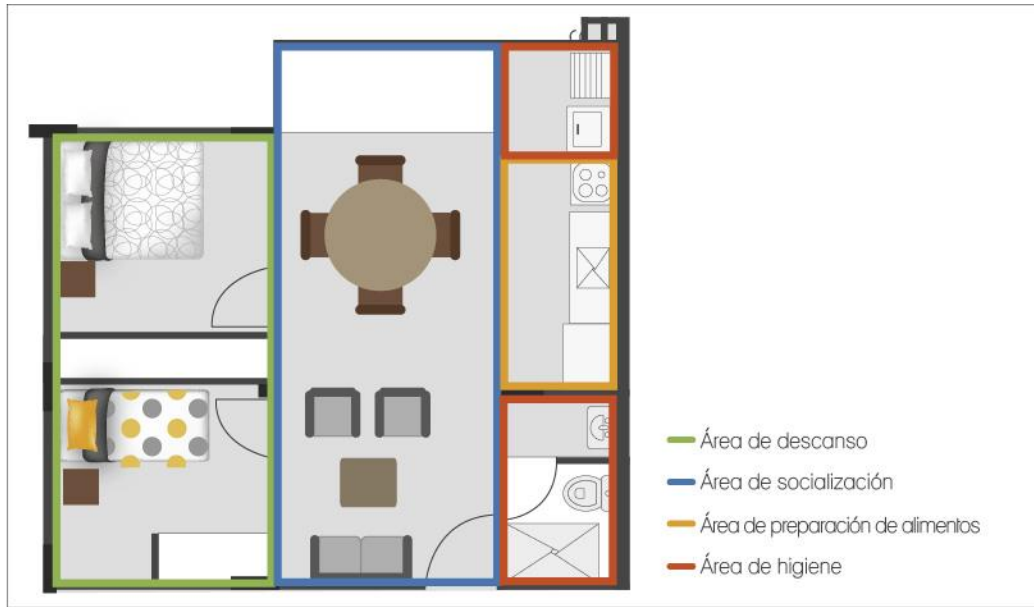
Vista en planta apartamentos ubicados en el barrio La Aurora.
